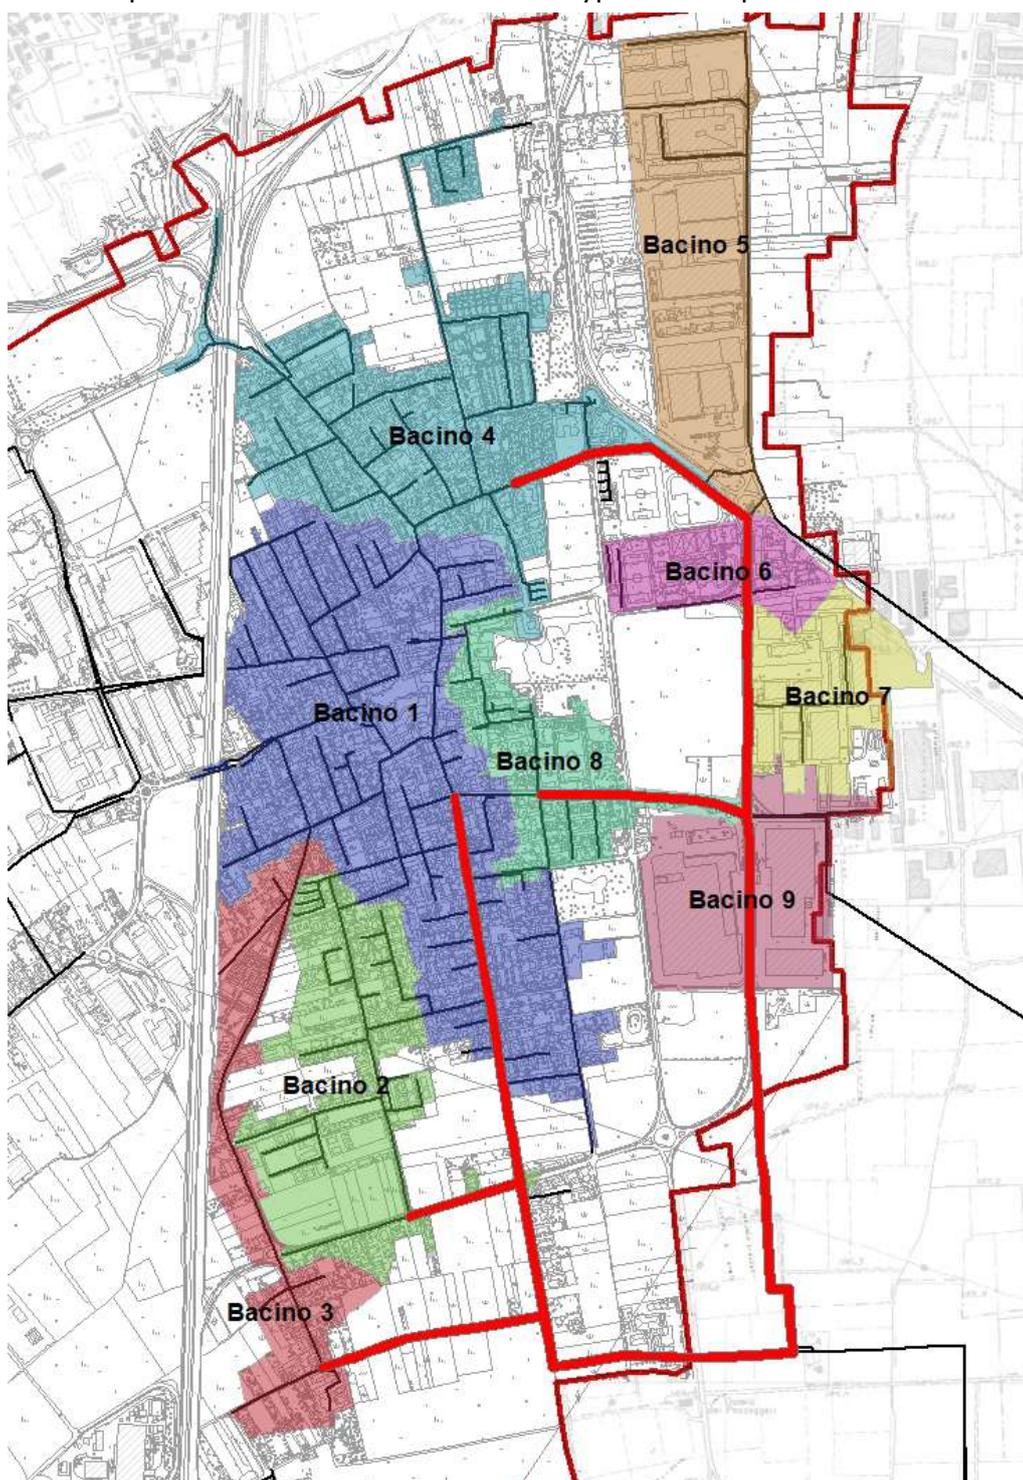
planimetria rete centro: le linee in rosso indicano le dorsali.
